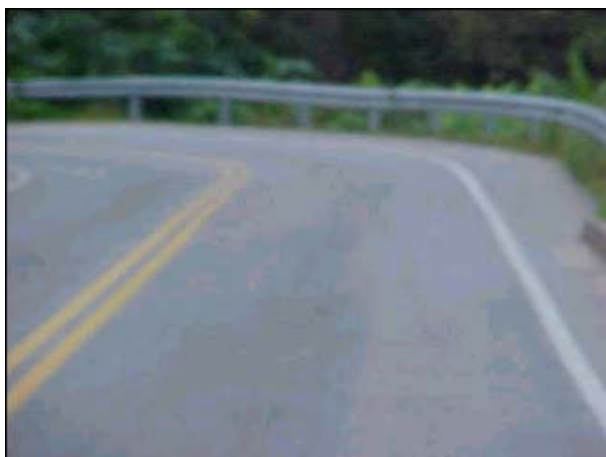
Detalhe dos dispositivos de segurança do tipo defensas metálicas
